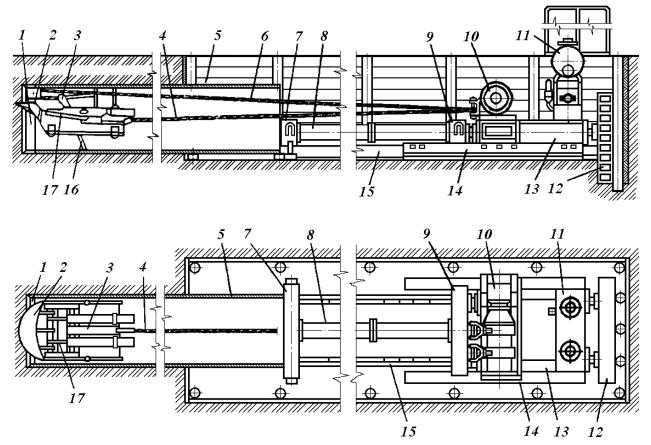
Установка для прокладки труб продавливанием с механизированной разработкой грунта
